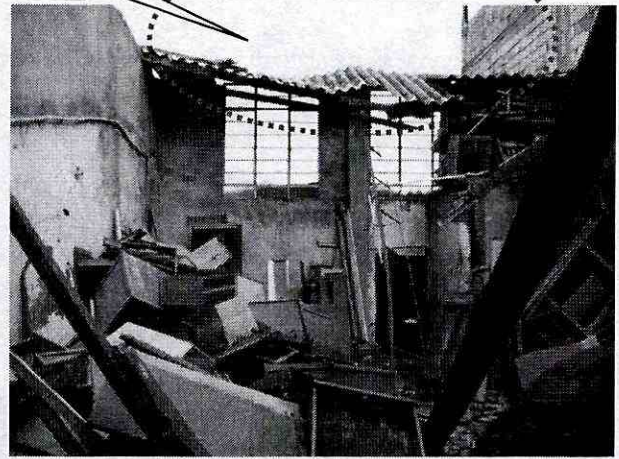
Colapso parcial de la cubierta y afectaciones en el taller de carpintería.
